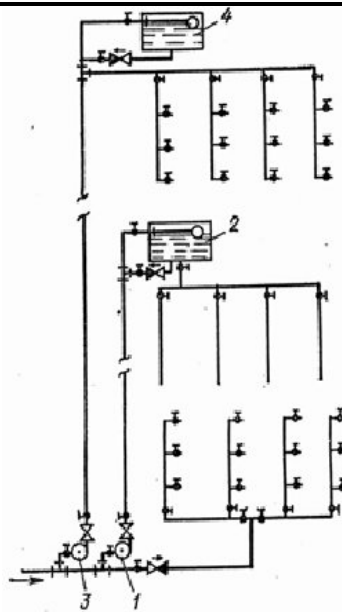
Параллельная схема зонных водопроводов зданий:
